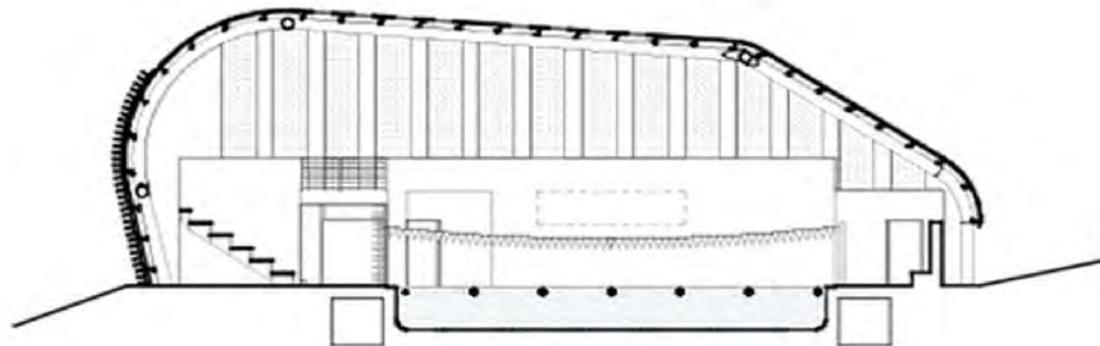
Corte Arquitectónico del centro acuático AISJ.
